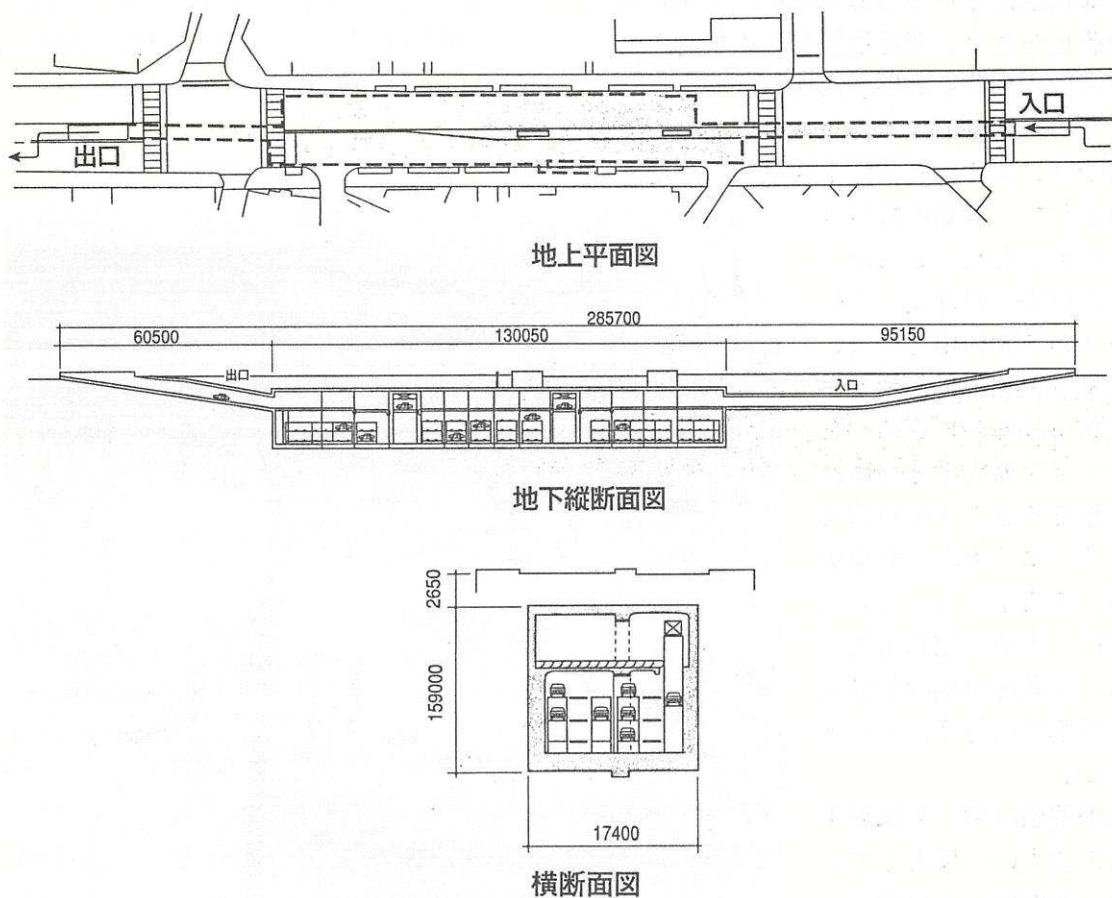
一般図（地上平面図・地下縦断面図・横断面図）
